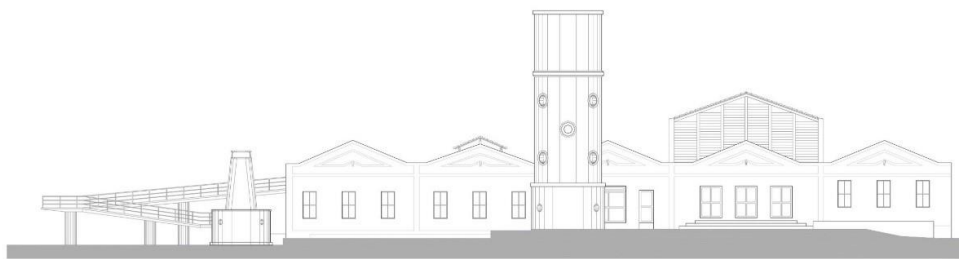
Fachada Sul do ECOA. Sobral/Ce.
